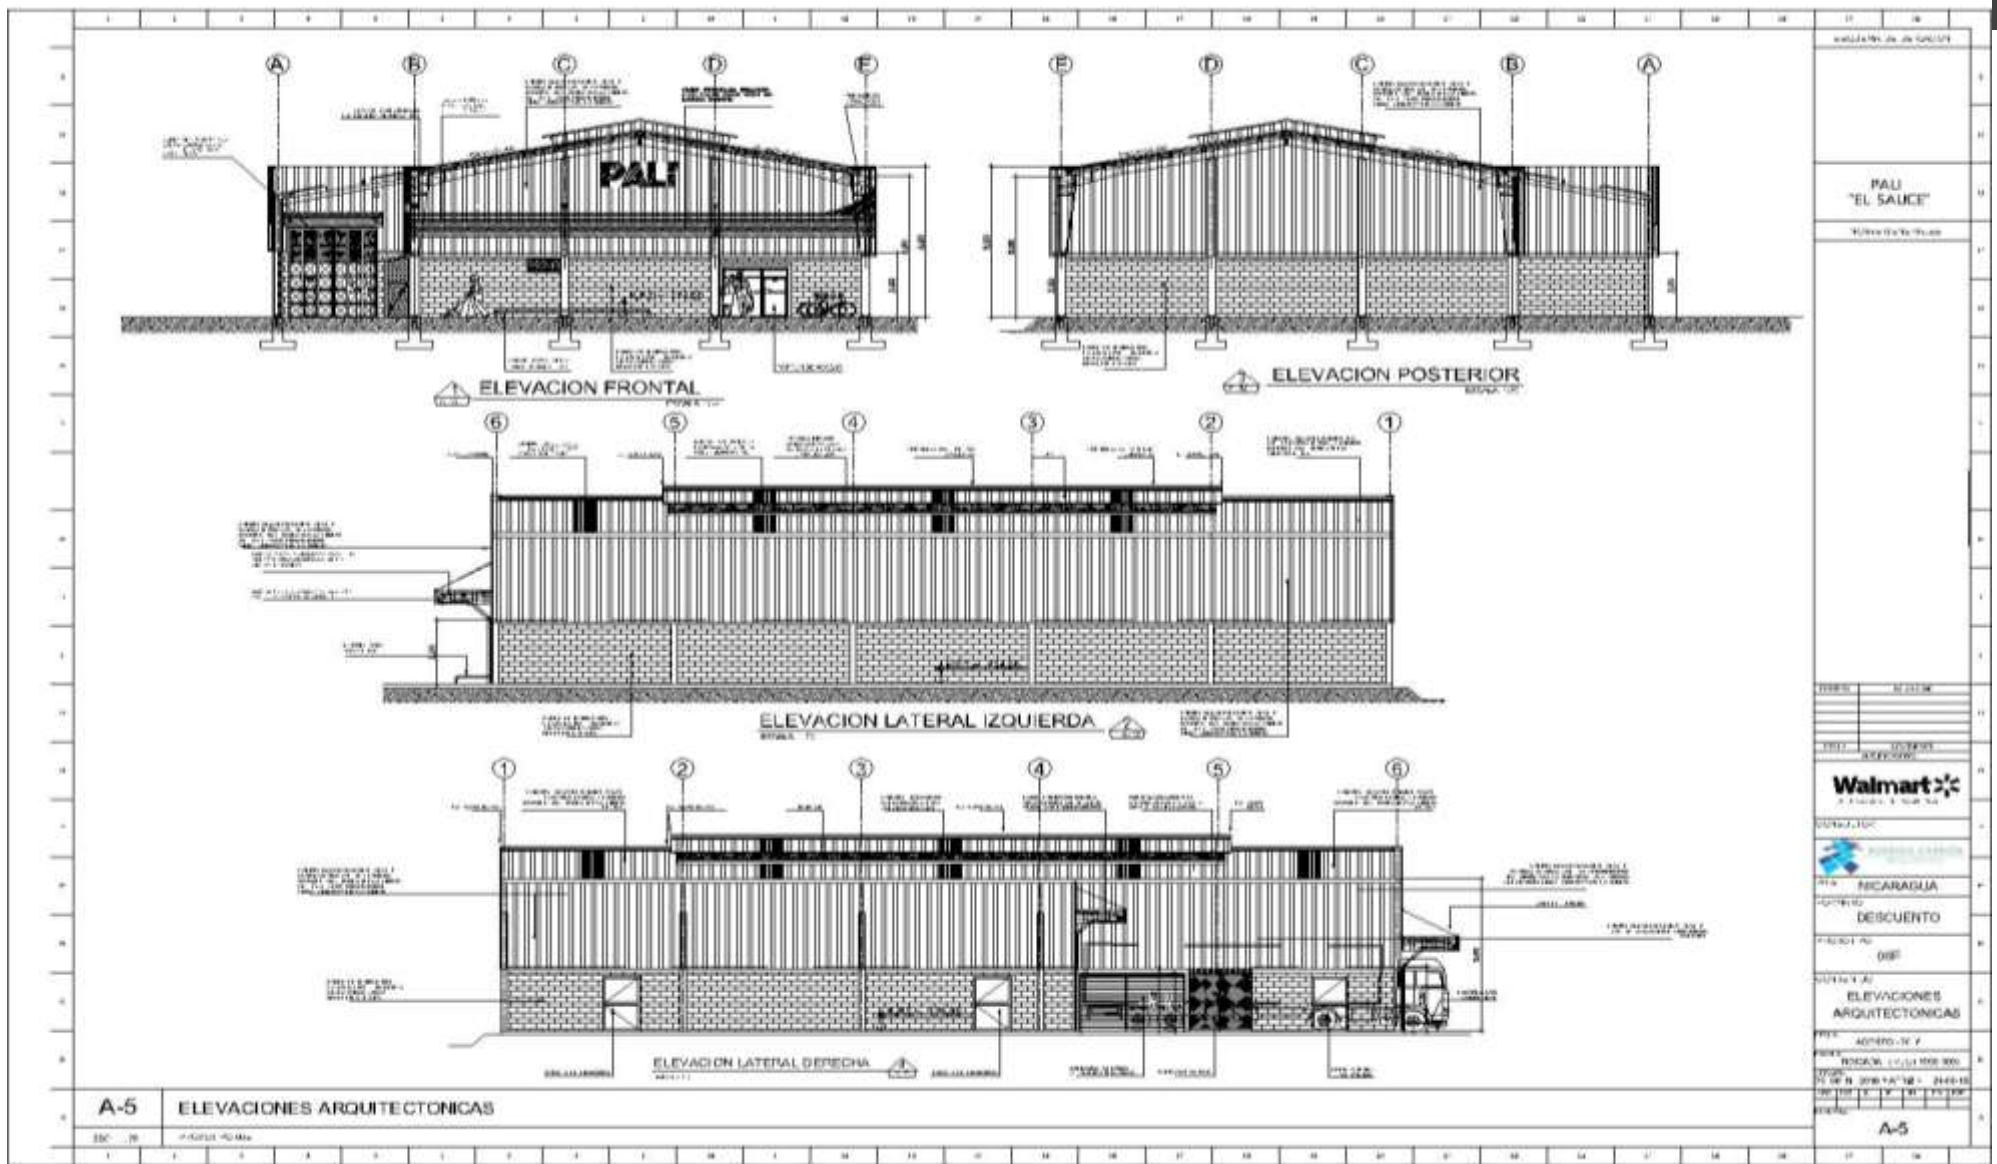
Elevaciones Arquitectónicas del Anteproyecto Pali El Sauce, León. Fuente: Elaboración Propia.
